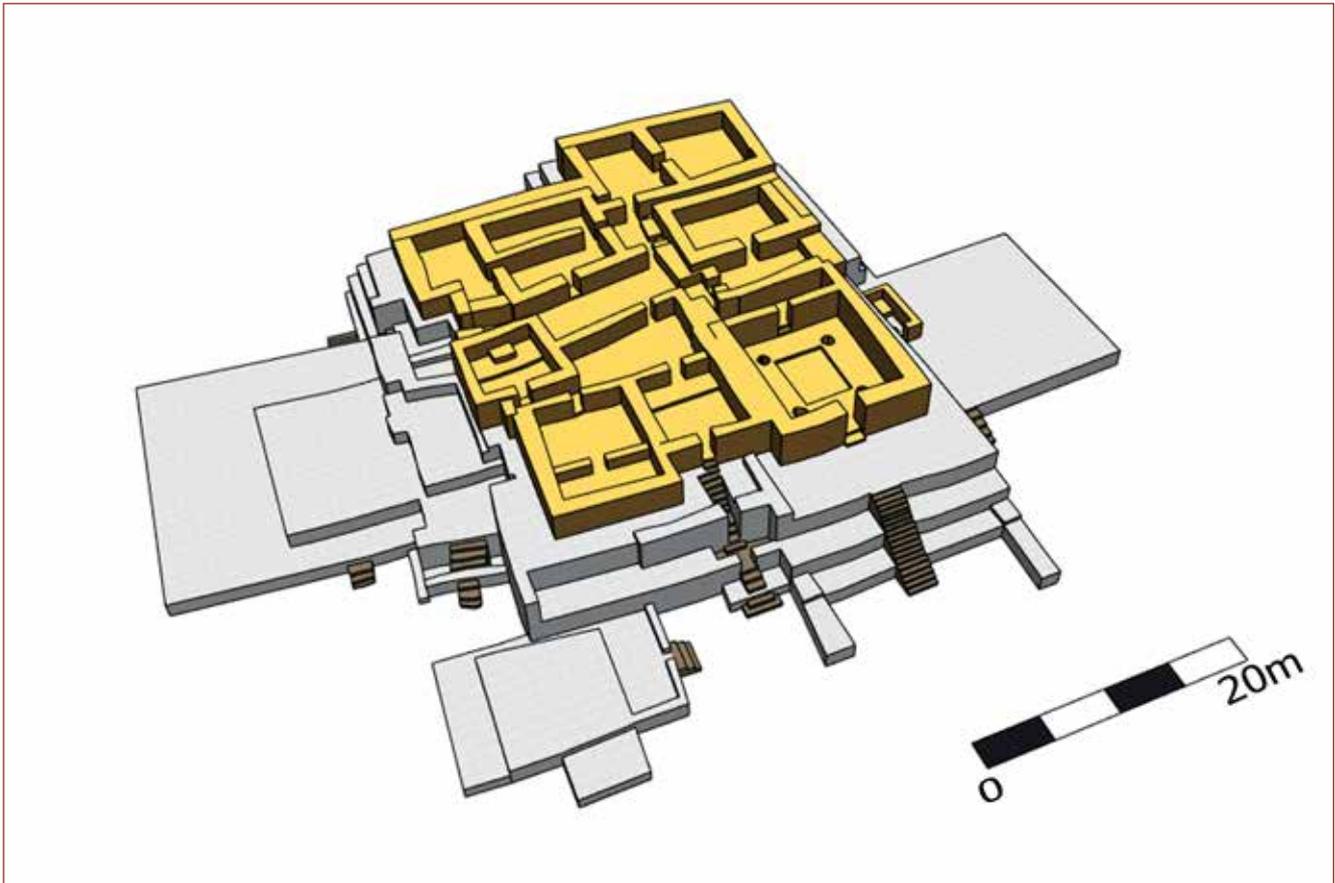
Isometría de la fase constructiva final de la Unidad Arquitectónica I.
